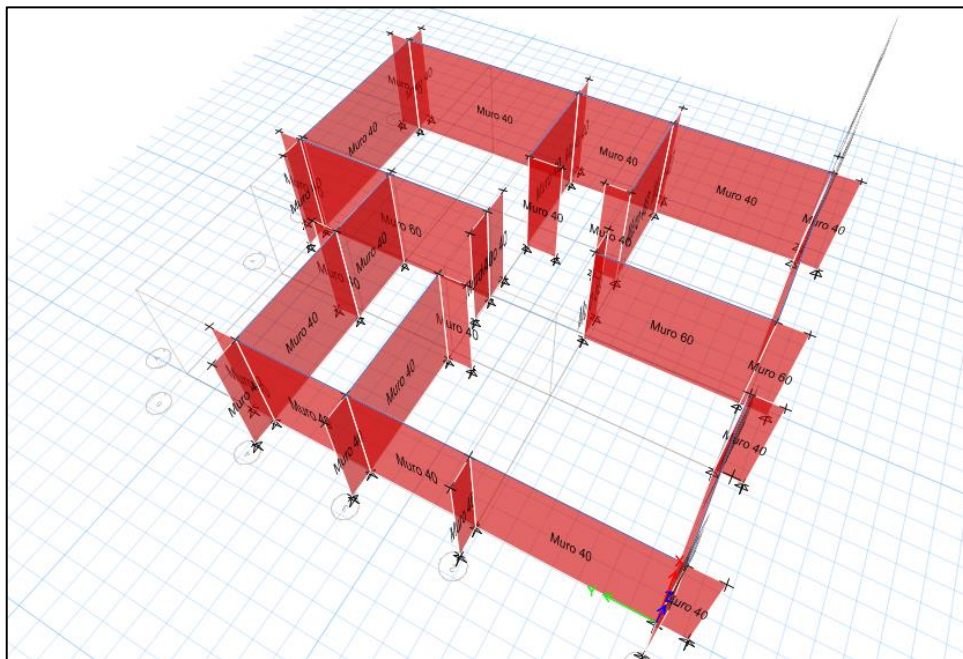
Modelado de la estructura – espesores de muro. Fuente: Elaboración propia.
